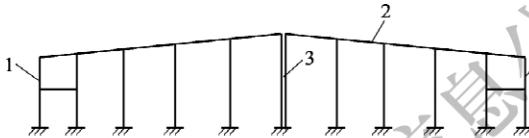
普通钢筋混凝土框架结构厂房
